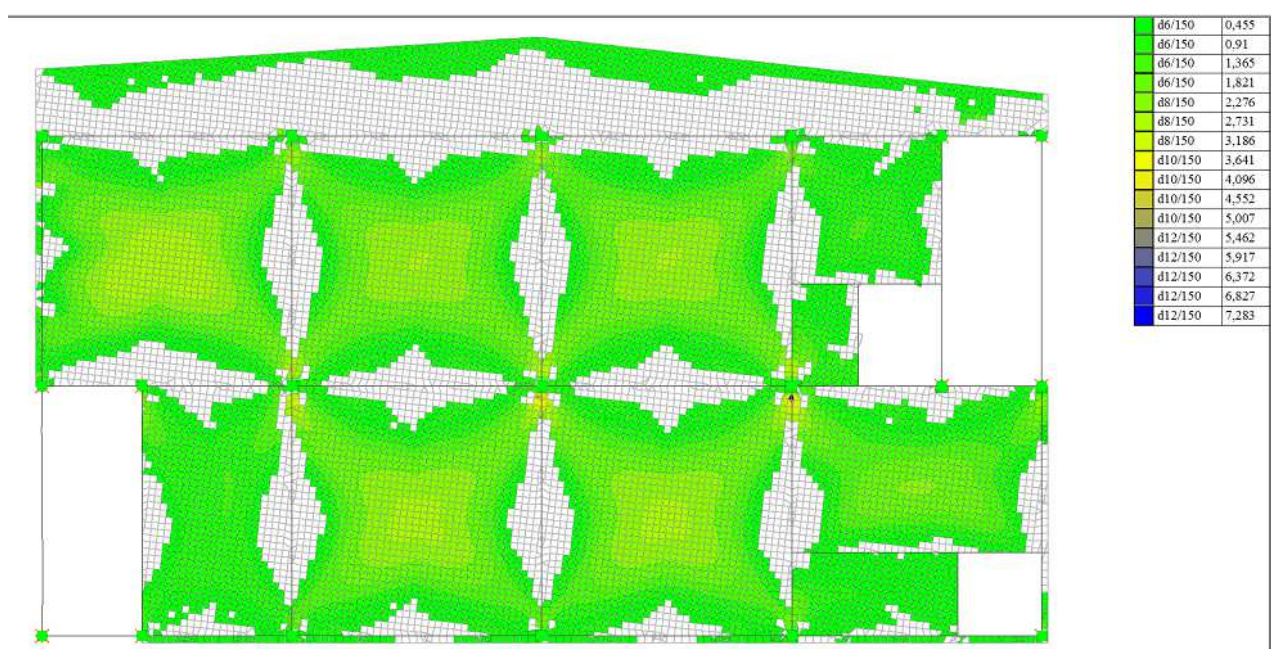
Схема нижнего армирования плиты по оси y
